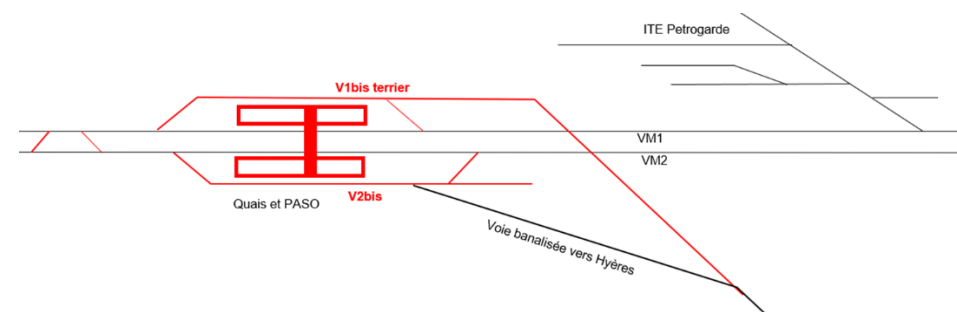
Plan de voie projeté (source : Egis, 2021)
